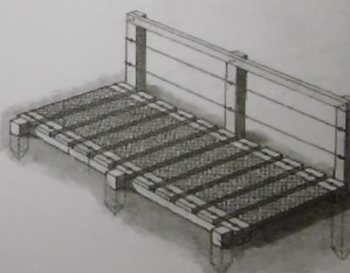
Detalhes construtivos das passarelas de madeira.
